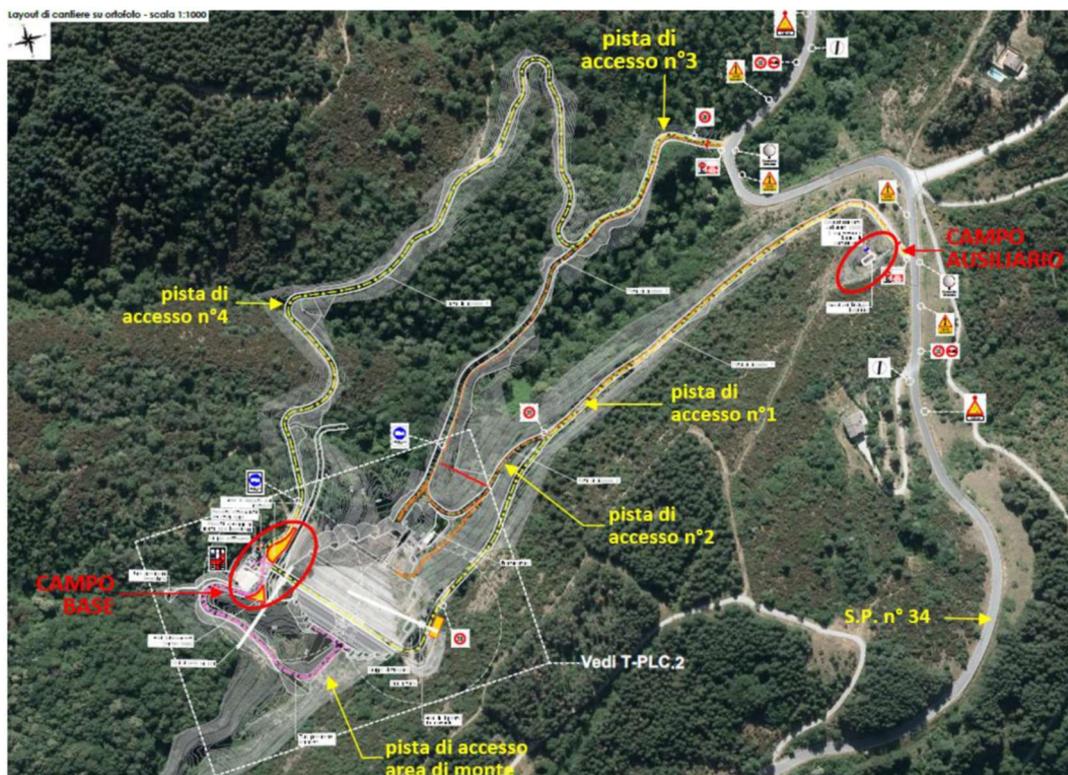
Rappresentazione su foto aerea delle piste di cantiere
